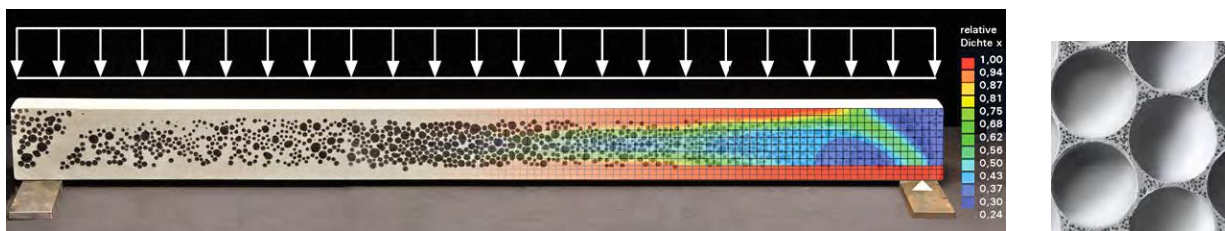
Ein-Material-Gradientenbeton, single material gradient concrete.
